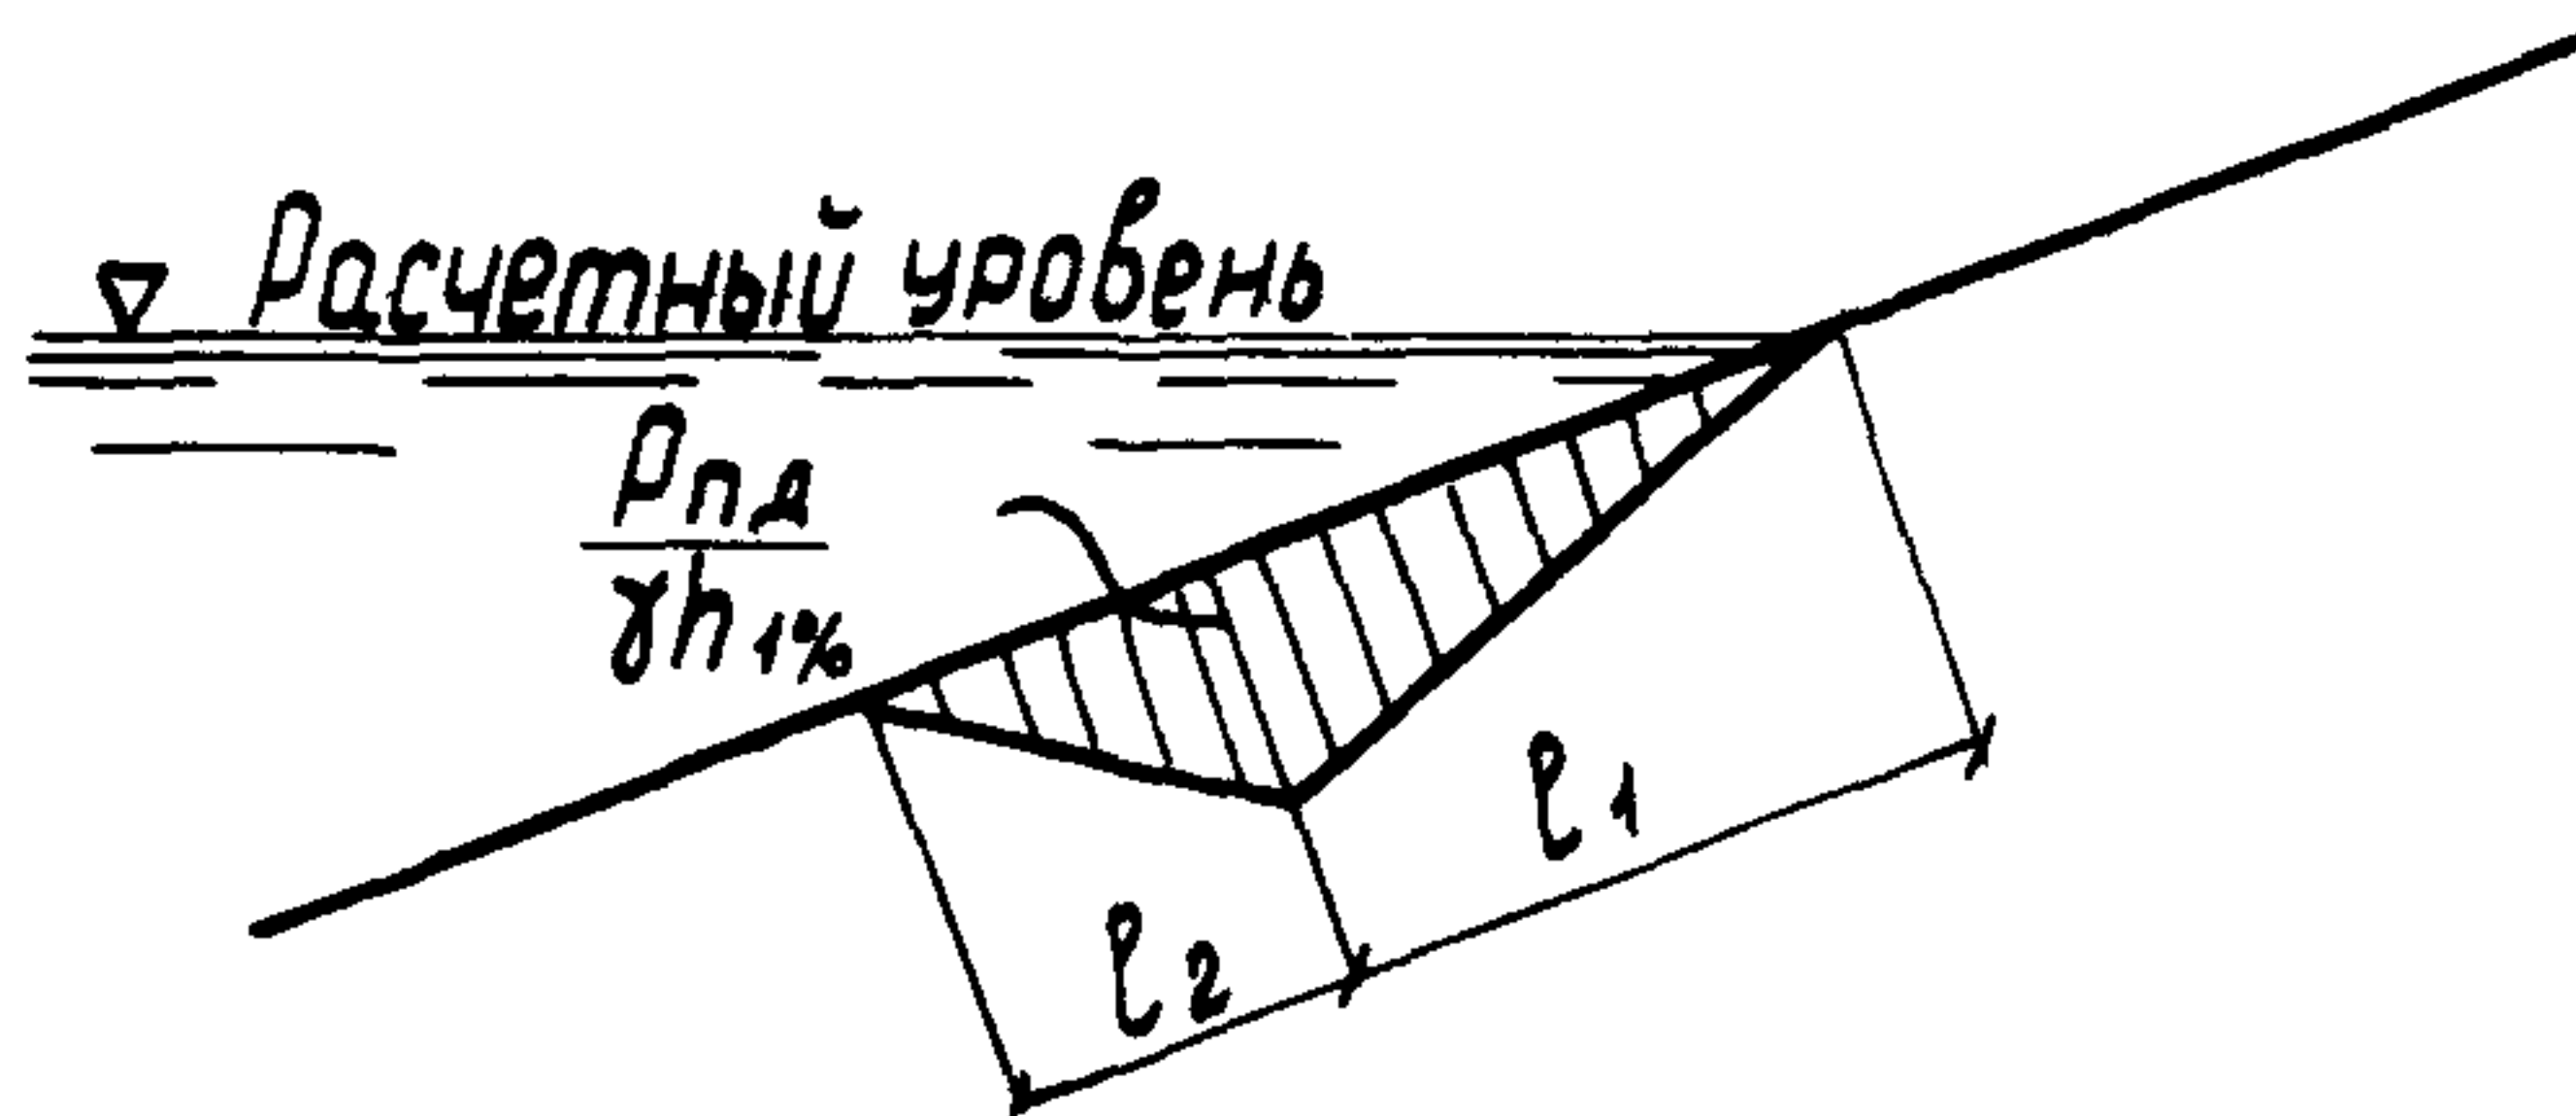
Типовая эпюра взвешивающей нагрузки на сплошное бетонное покрытие откоса при нерегулярном волнении.
